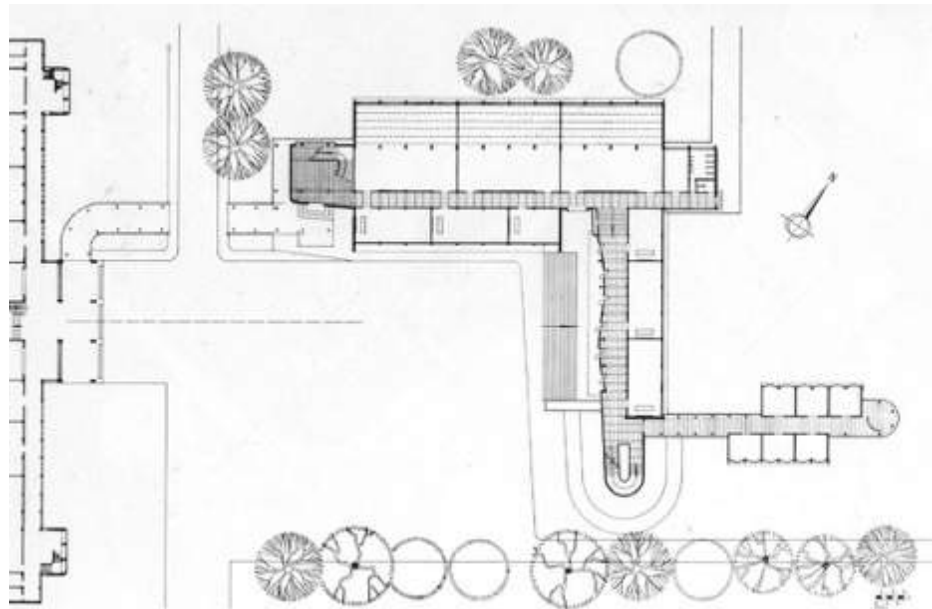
Edificio anexo de Ingeniería. Planta del primer piso. Arquitecto Leopoldo Rother.1945.El proyecto original, afín al del Servicio Geológico Nacional, fue radicalmente desfigurado en su proceso de construcción. (Dibujo tomado del libro Arquitecto Leopoldo Rother. Hans Rother. 1984.)
